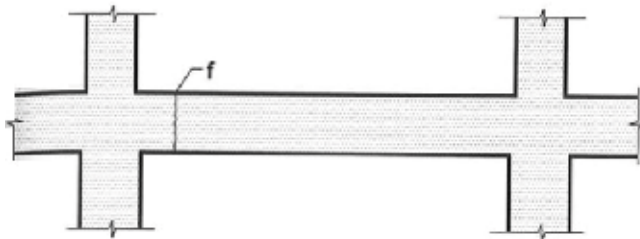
Fisura vertical en viga (Fuente: Calavera, 2005)
